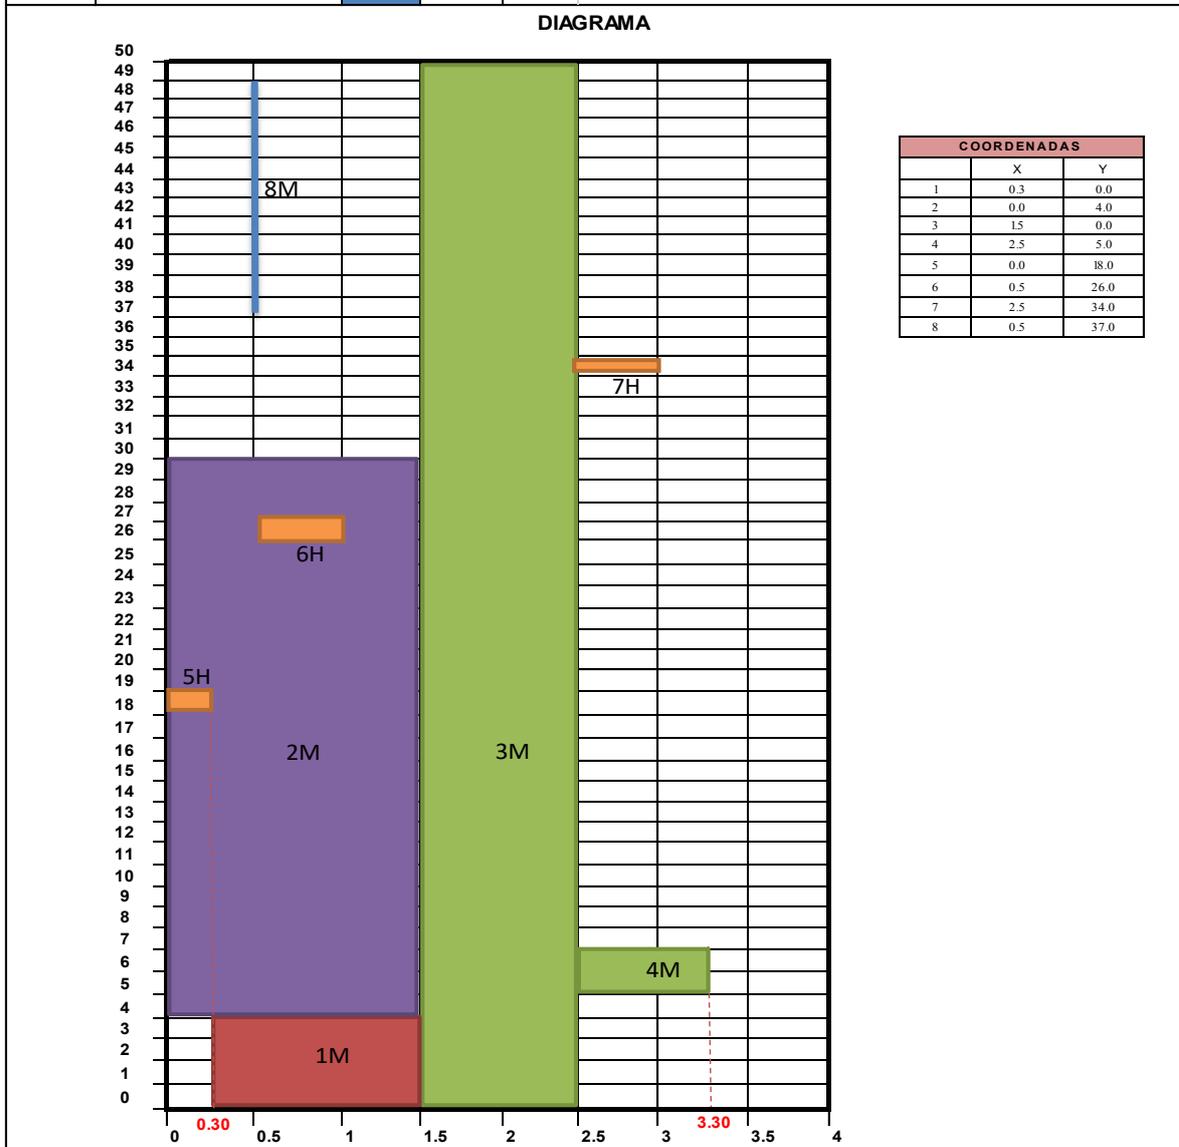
Ficha de Índice de condición del pavimento tramo TA 01
